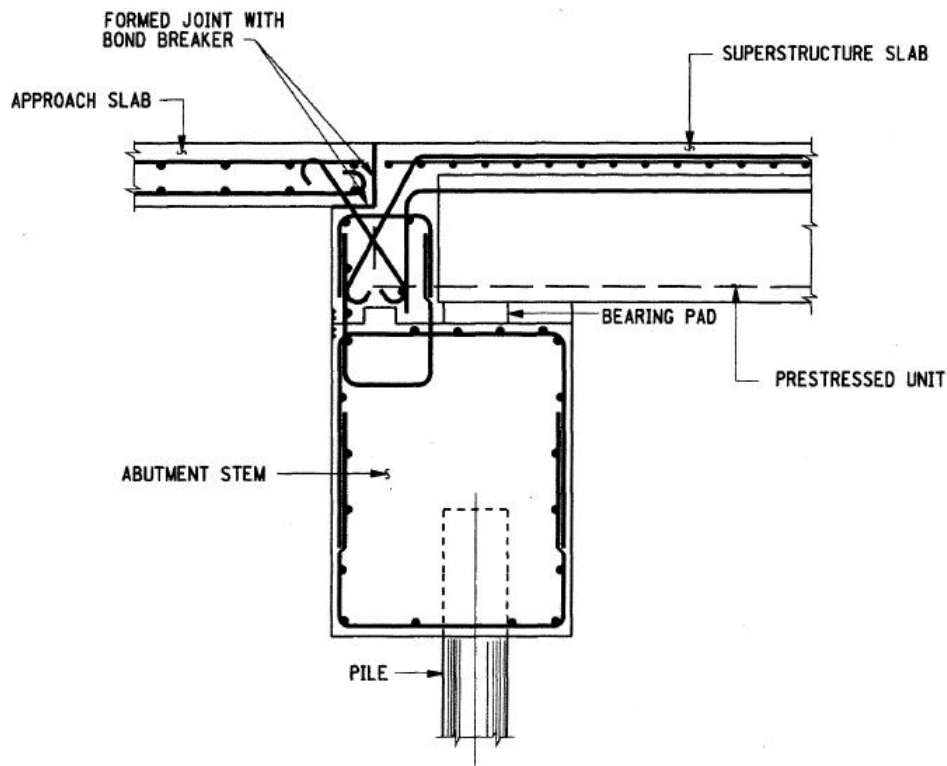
Betongelenk Anschluss Schleppplatte-Brückentragwerk [14]
